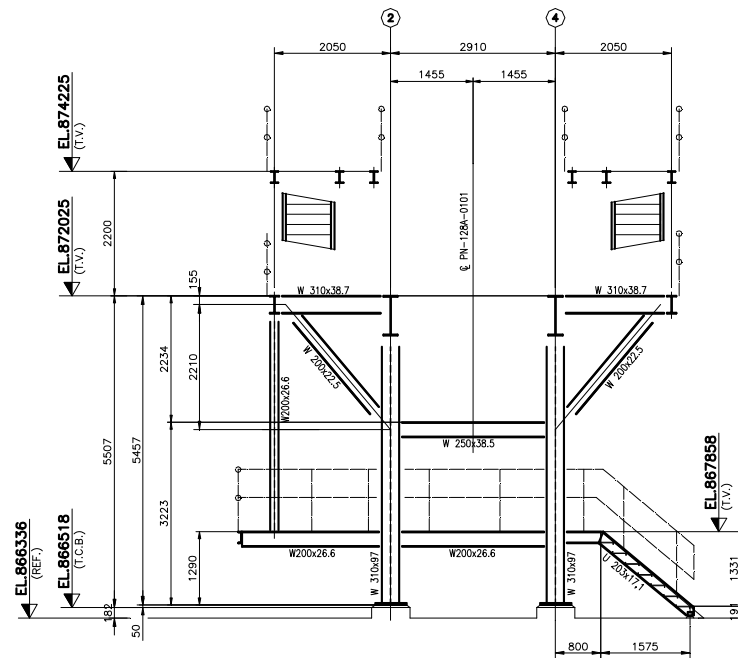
Desenho de Projeto – Elevação da Fila F.
